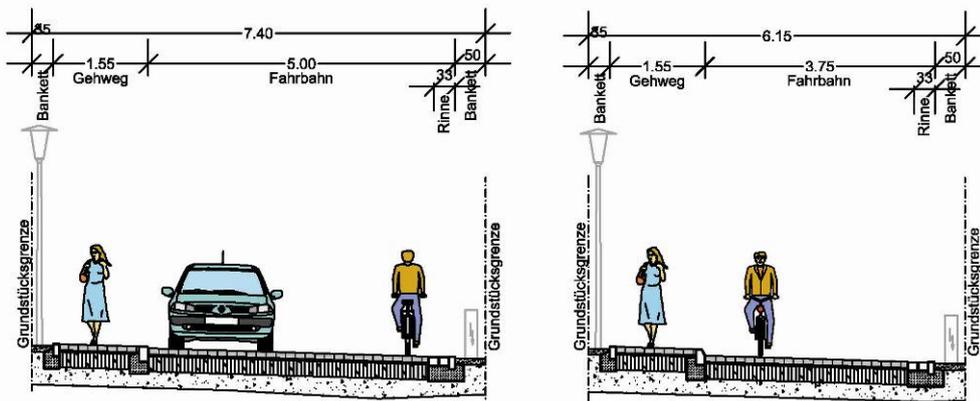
Regelquerschnitt Planstraße K sowie Regelquerschnitt Einengungsbereich
